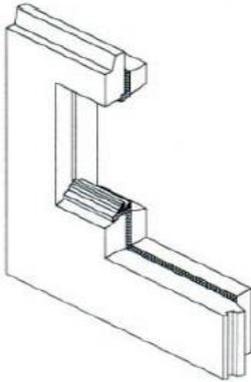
Panel prefabricado de hormigón armado tipo sándwich con uniones rígidas. Fuente: INTEMAC.
